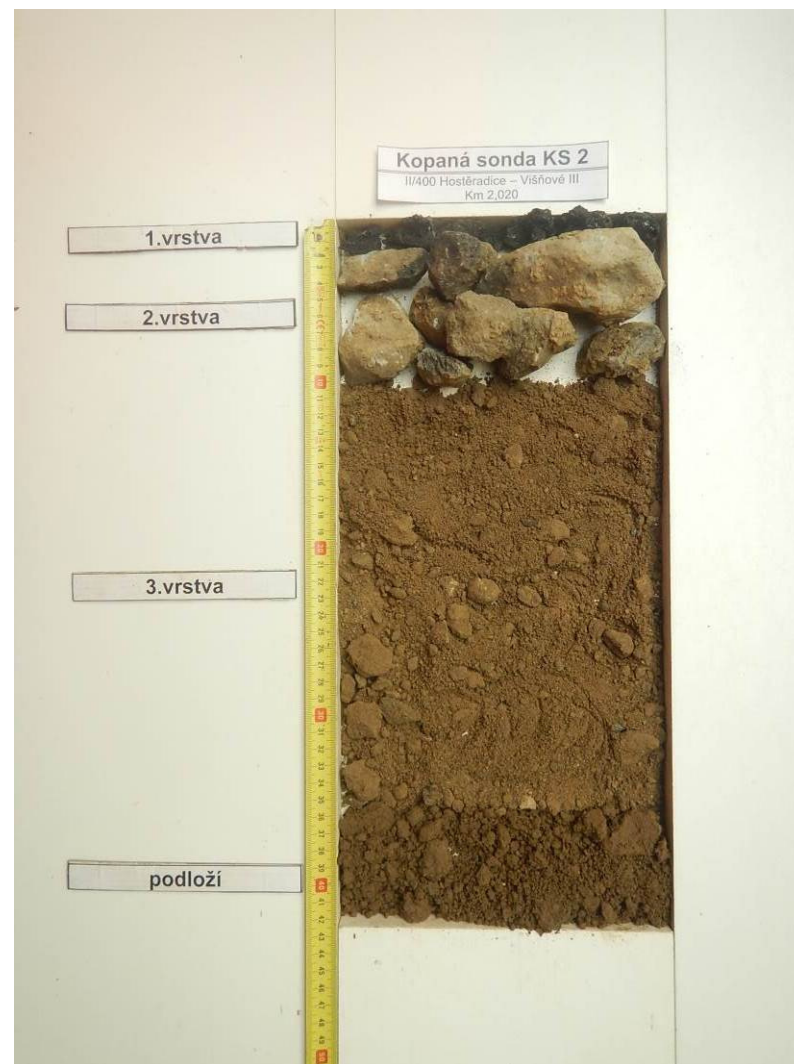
a č. 4 - Kopaná sonda KS 2
